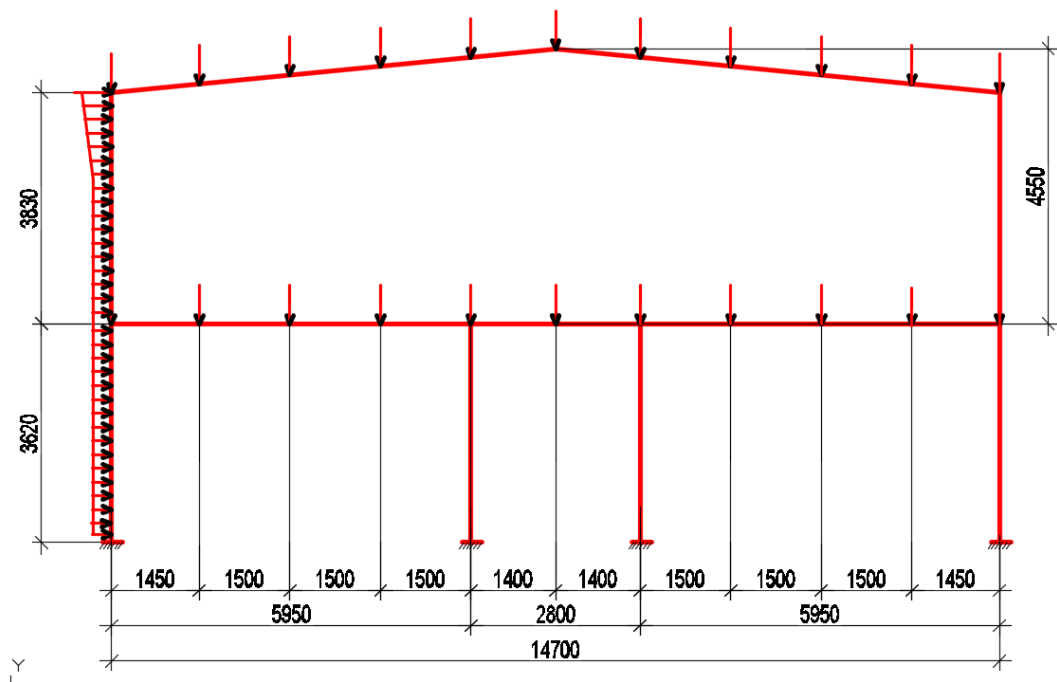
Расчетная схема стальной рамы каркаса
